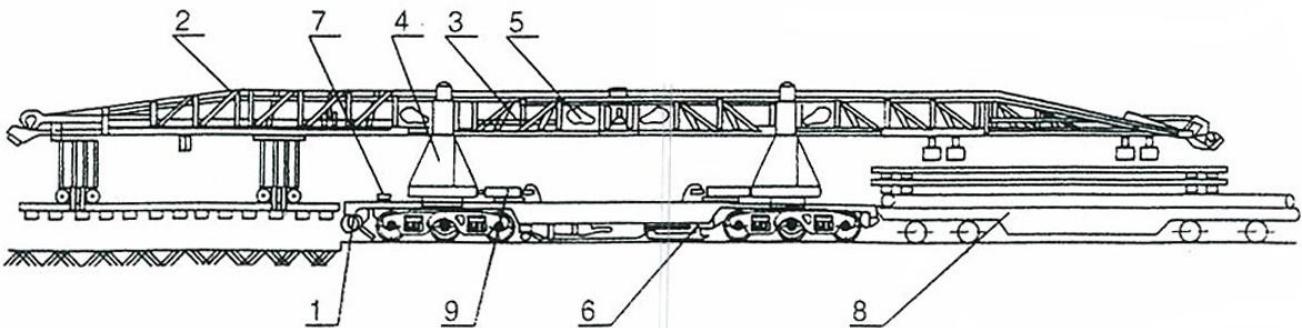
Укладочный кран УК-25СП: 1 – экипажная часть; 2 – металлоконструкция; 3 – оборудование грузовое; 4 – портал; 5 – электрооборудование фермы; 6 – электрооборудование платформы; 7 – гидрооборудование; 8 – специальный подвижной состав; 9 – гидроцилиндр
